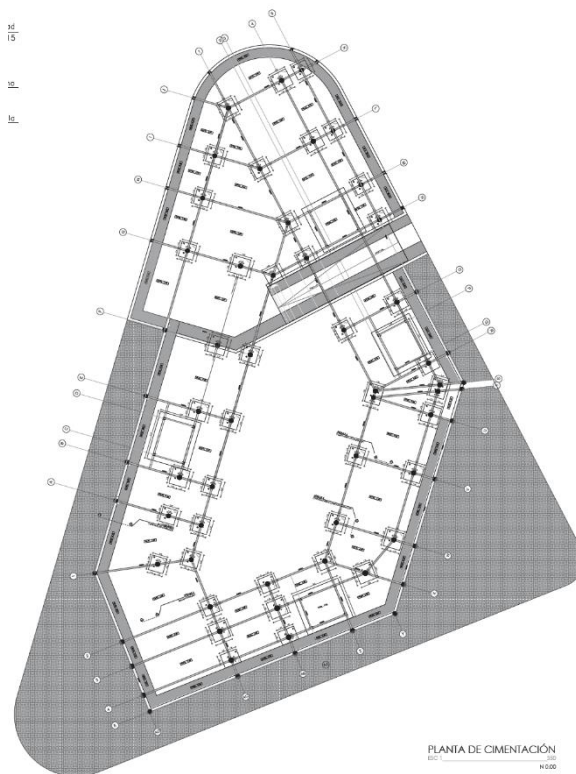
Planta de cimentación. (Villegas, C. 2021).
